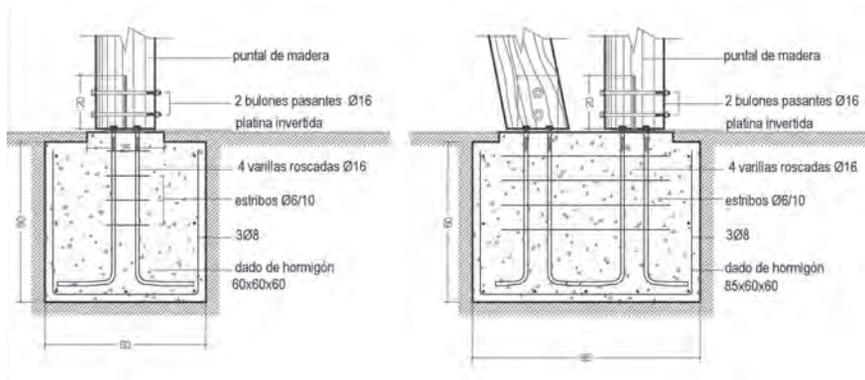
Dibujo lineal. Elaboración propia. Fundación de pilares, reconstrucción en 2009
